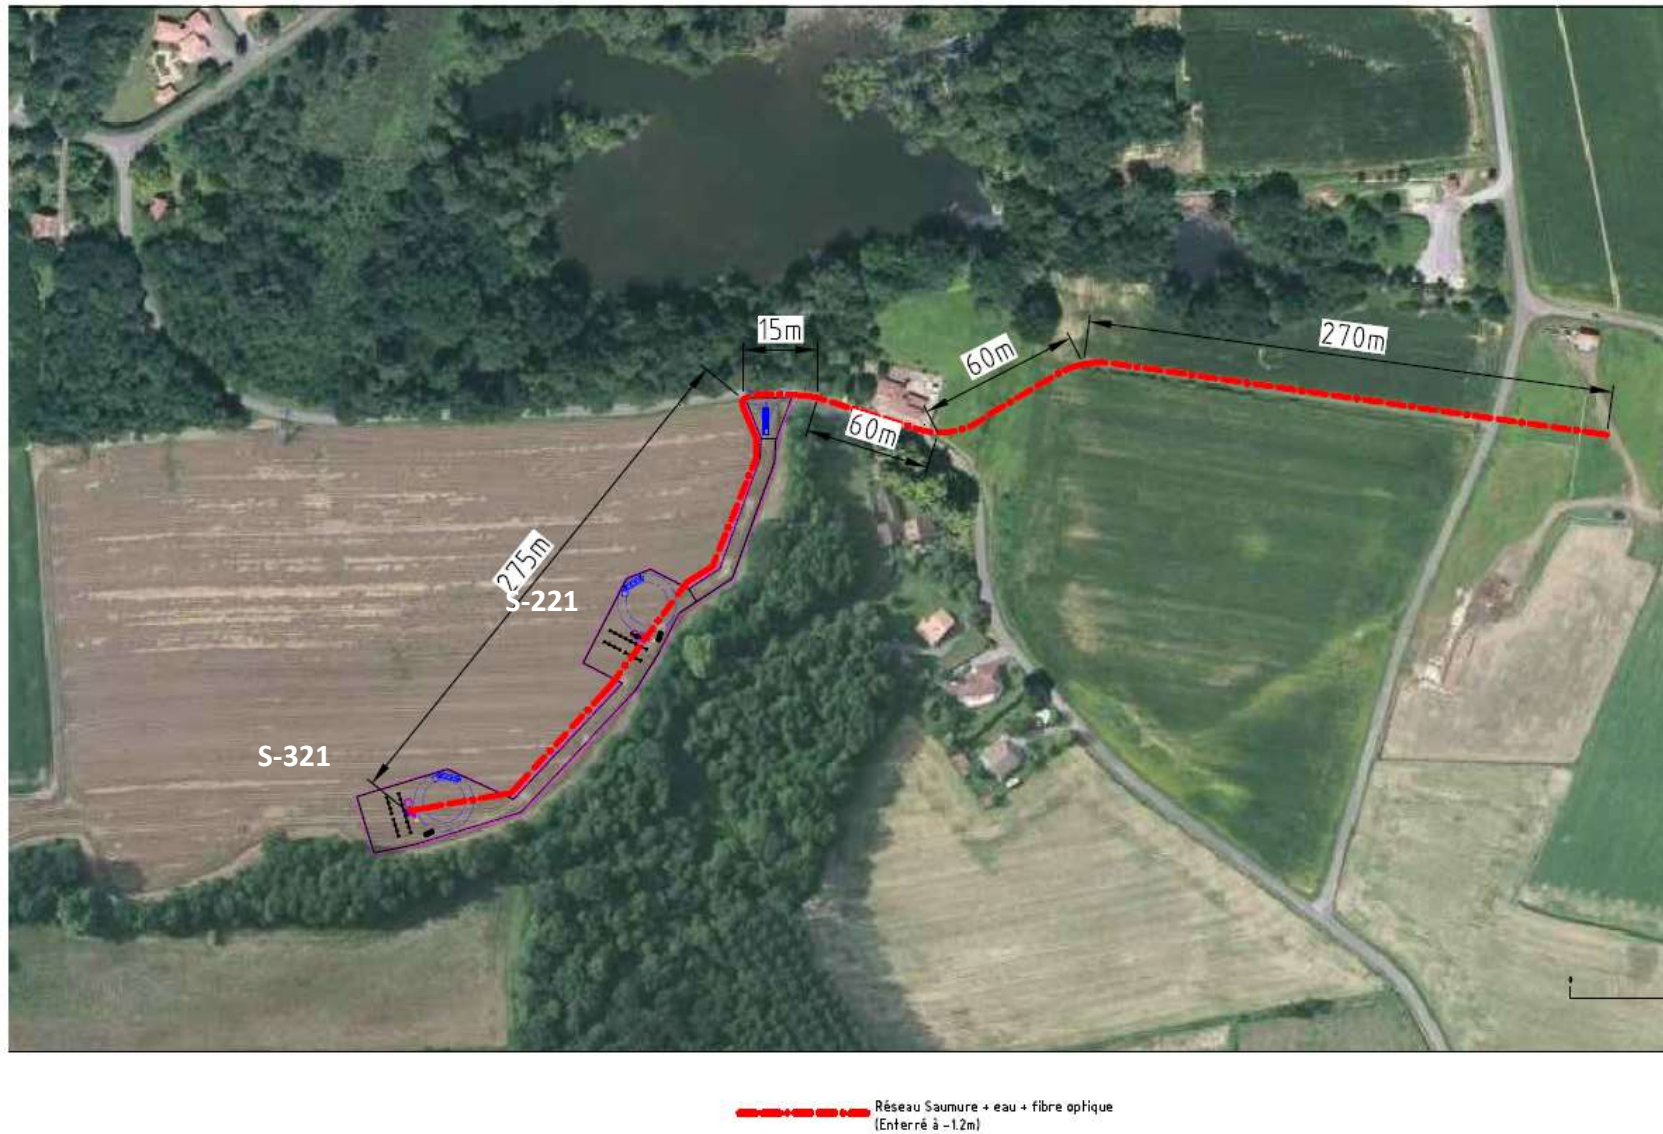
Plan général de localisation des forages et des réseaux de collecte
